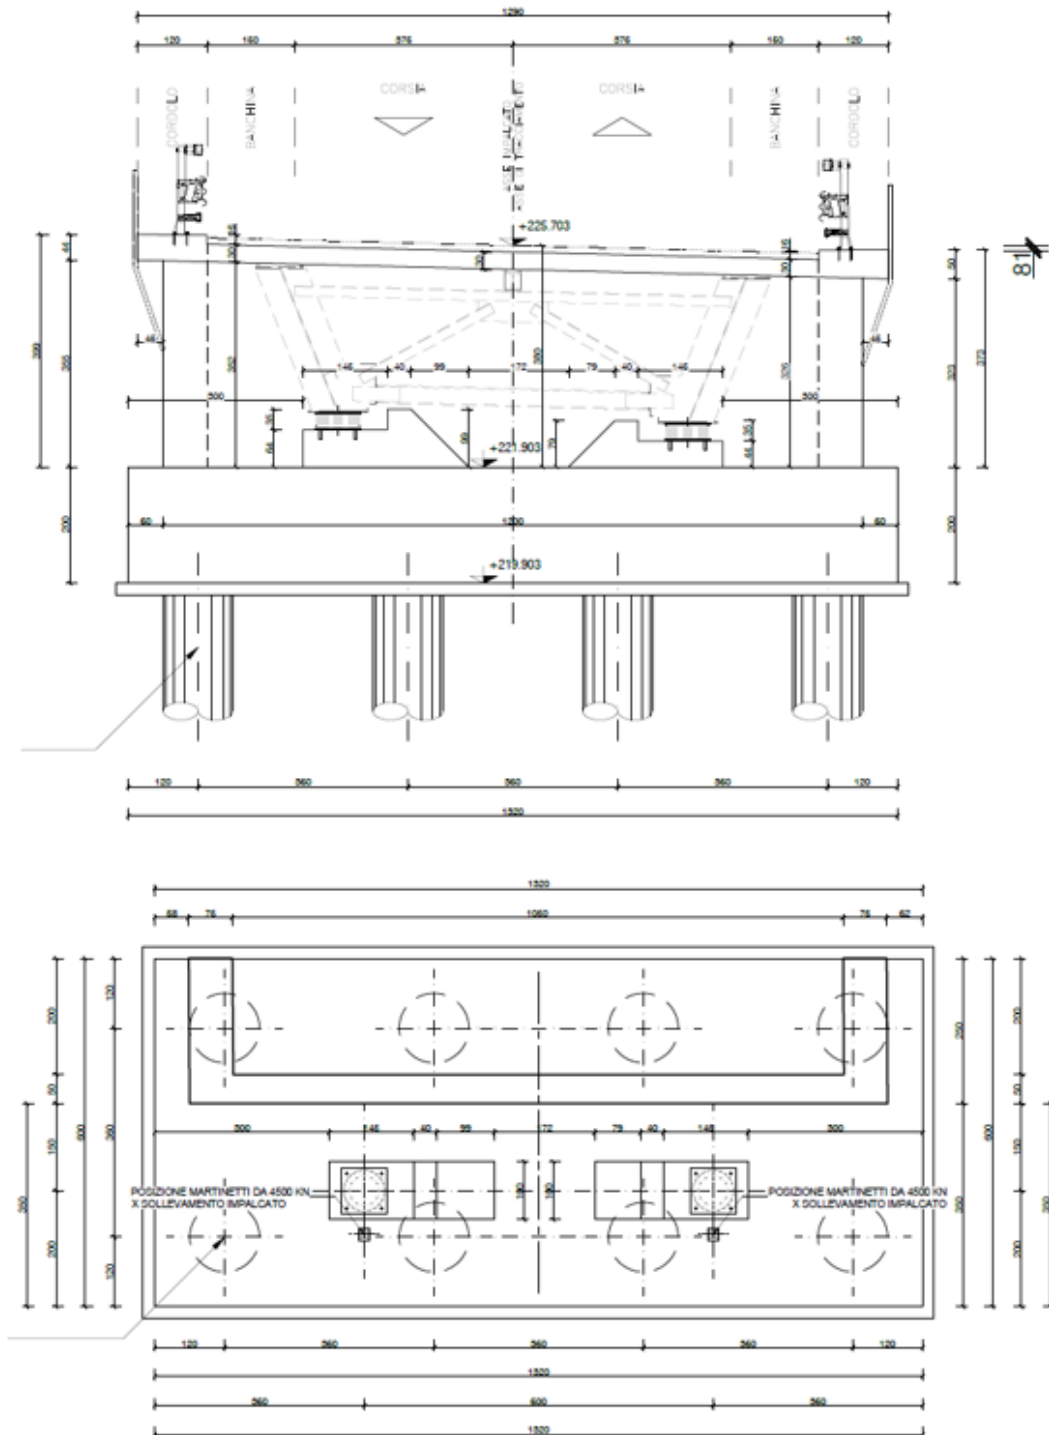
Spalla A. Vista trasversale e in pianta
